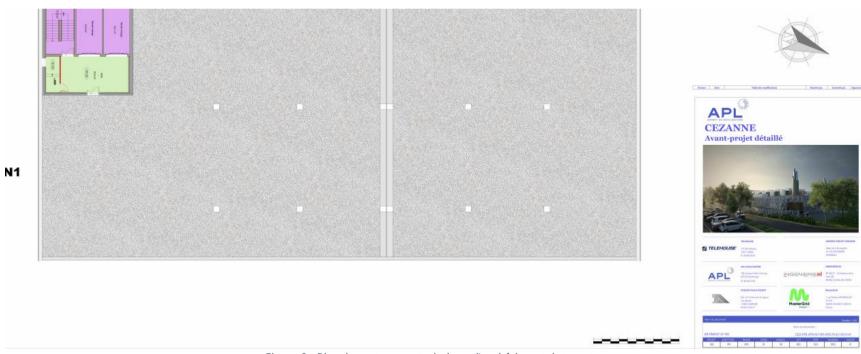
Plan étage terrasse technique d'un bâtiment datacenter
